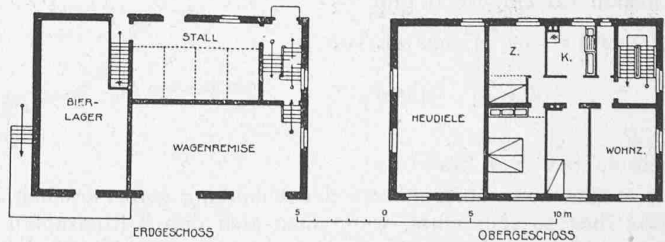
und 20. Grundrisse der Brauerei-Niederlage. — 1:400.
